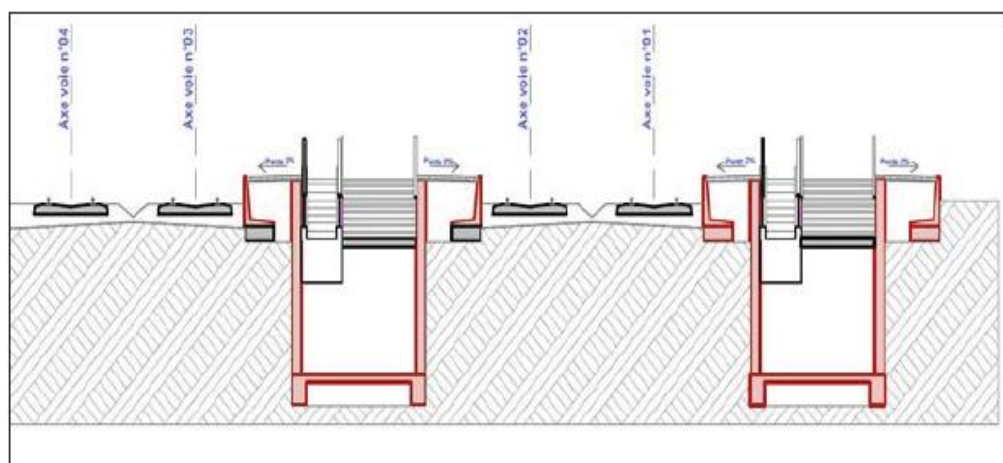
Coupe transversale de la gare de Hadjout [1]
